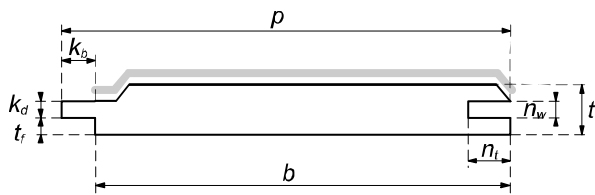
Section d'une planche profilée rainée-crêtée (schématisée).
